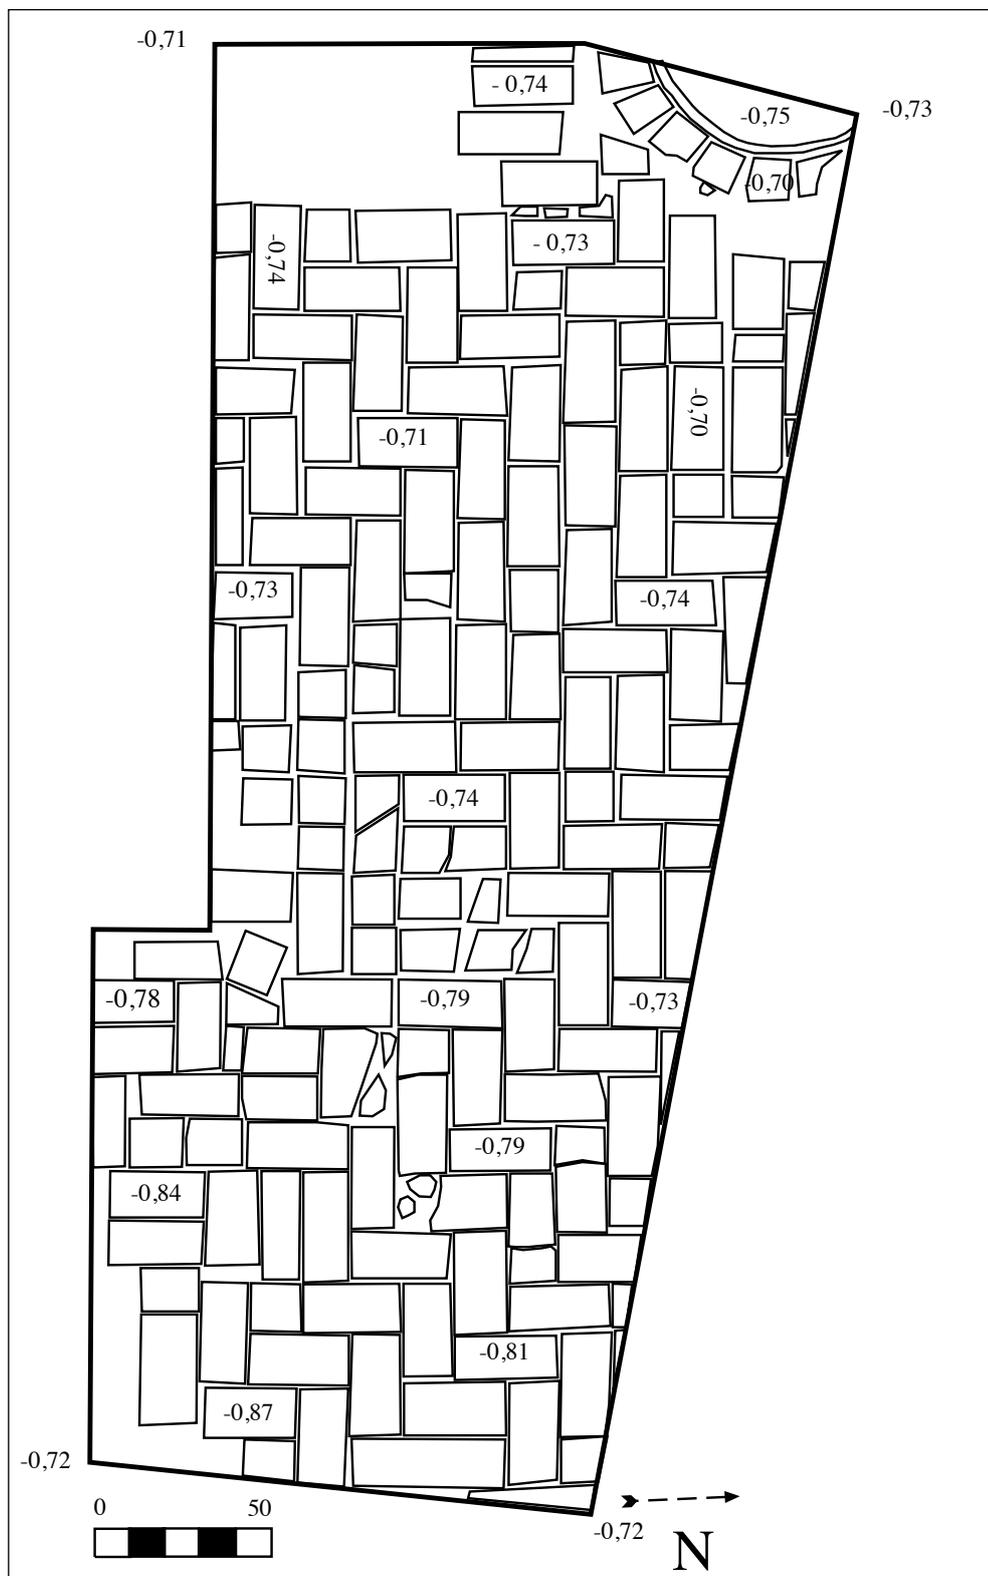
Periodo I. Fase II. Pavimento de ladrillo en zig-zag hallado en el transcurso de la excavación arqueológica.
